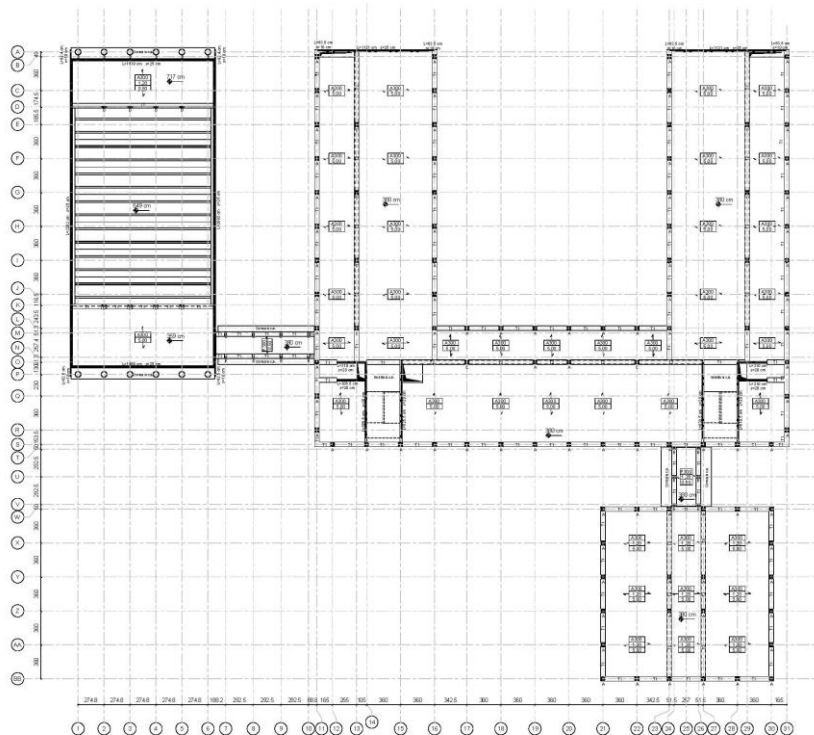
Edificio B: Vista speculare impalcato piano primo
